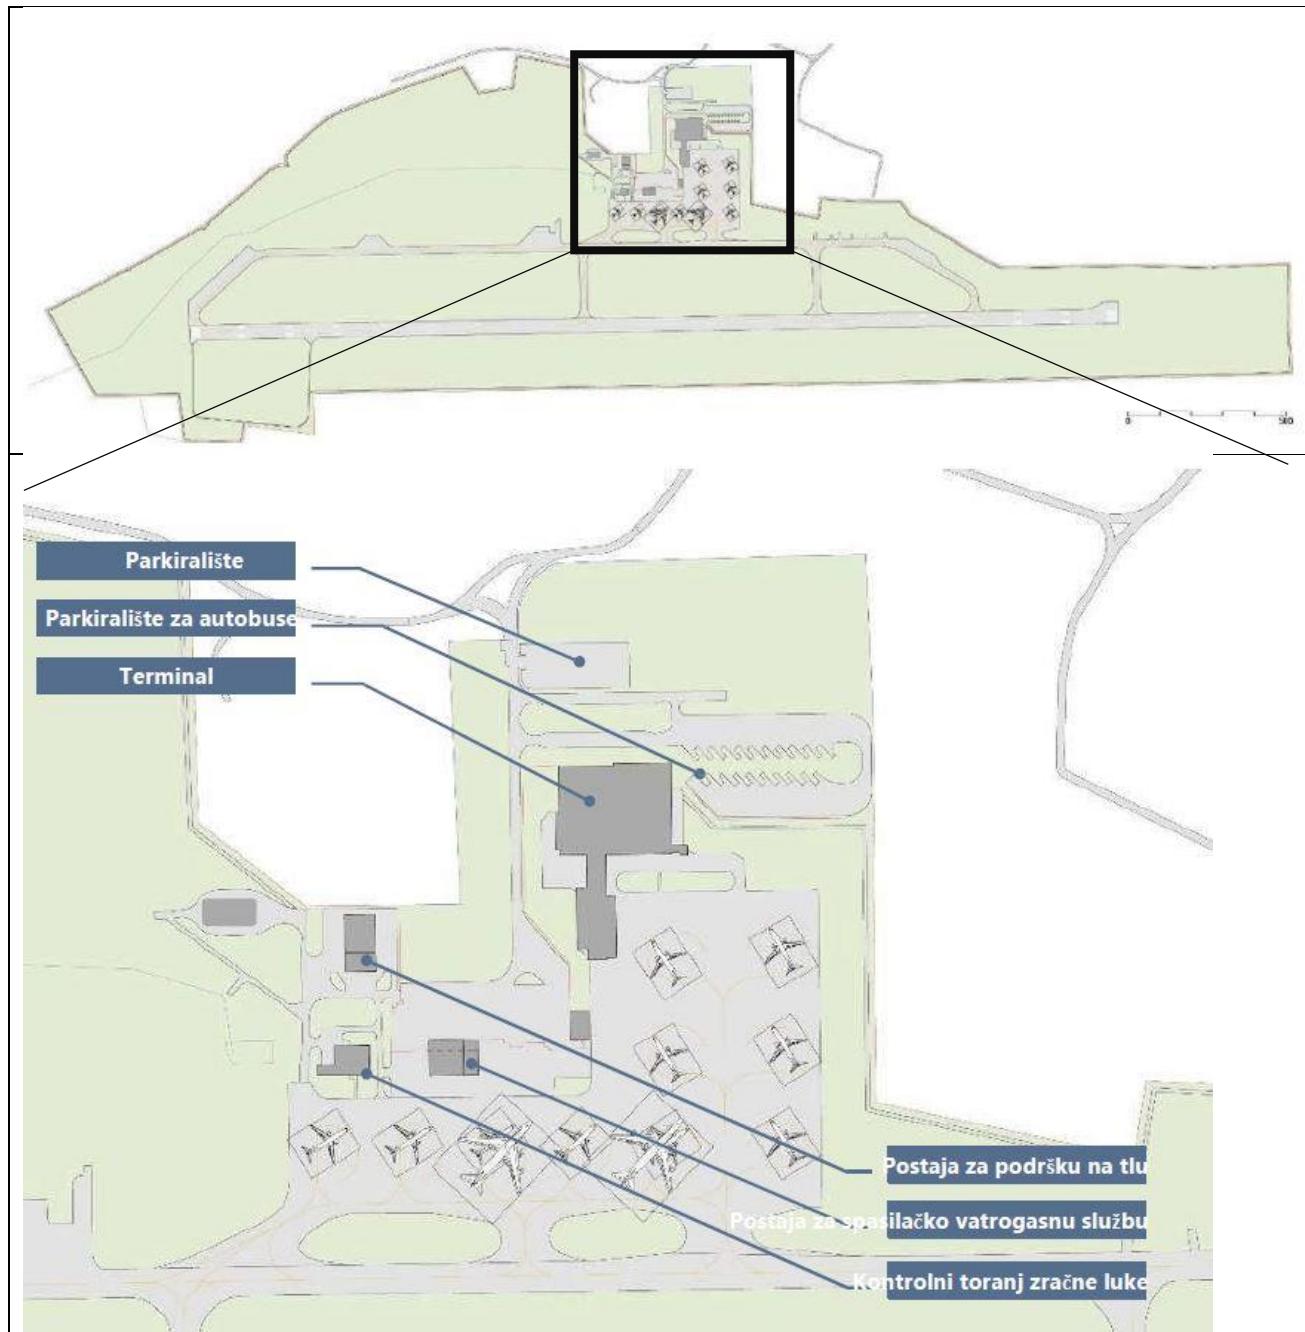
Plan upotrebe zemljišta (Izvor: Master plan)
